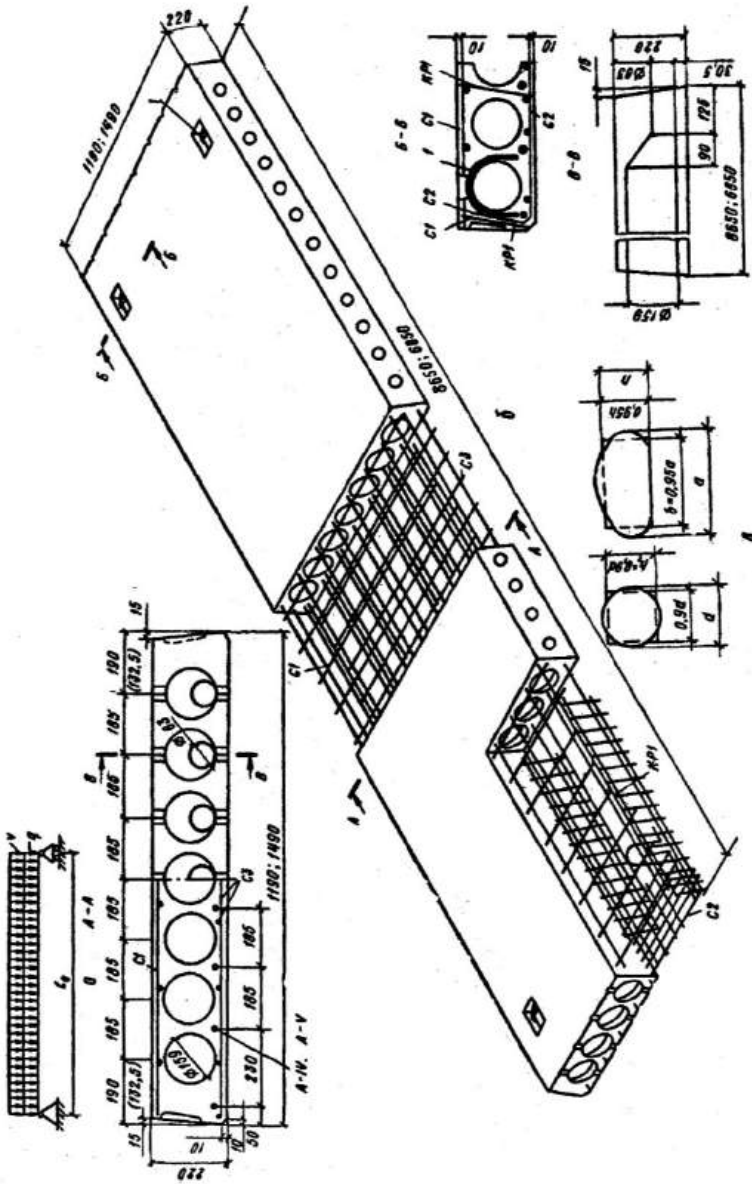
Багатопорожниста плита перекриття: *a* – розрахункова схема; *б* – загальний вигляд плити; *в* – дійсні та еквівалентні розрахункові перерізи круглих та овальних порожнин плит
